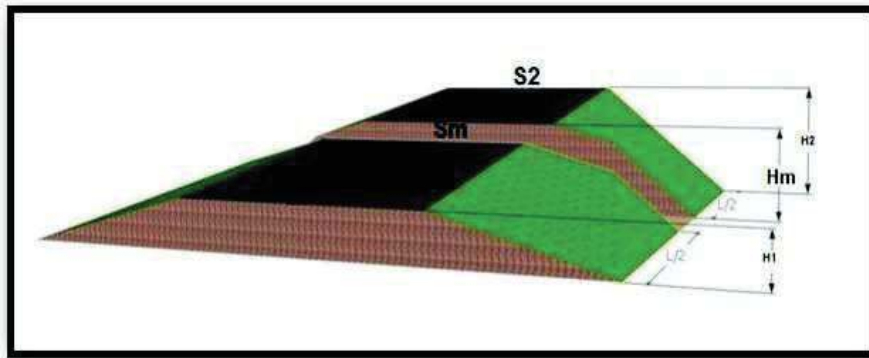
Les sections des profils en travers d'un tracé donné.
